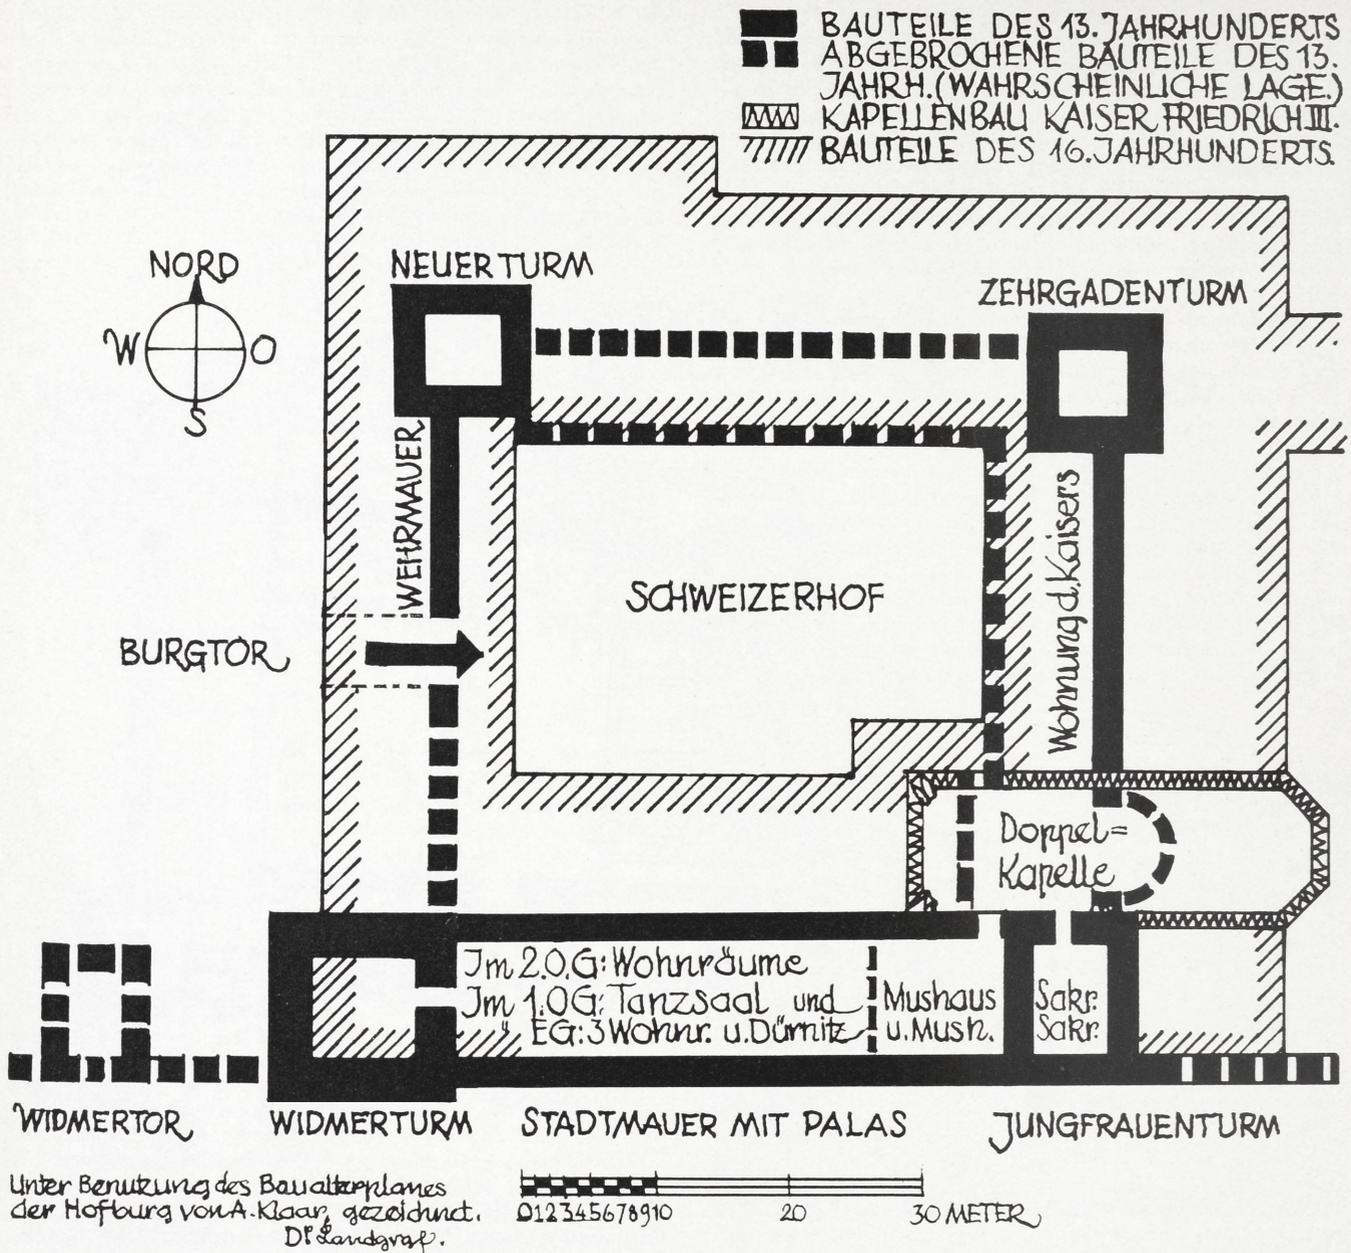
Wien, Hofburg, Grundriß, M. 1:800
